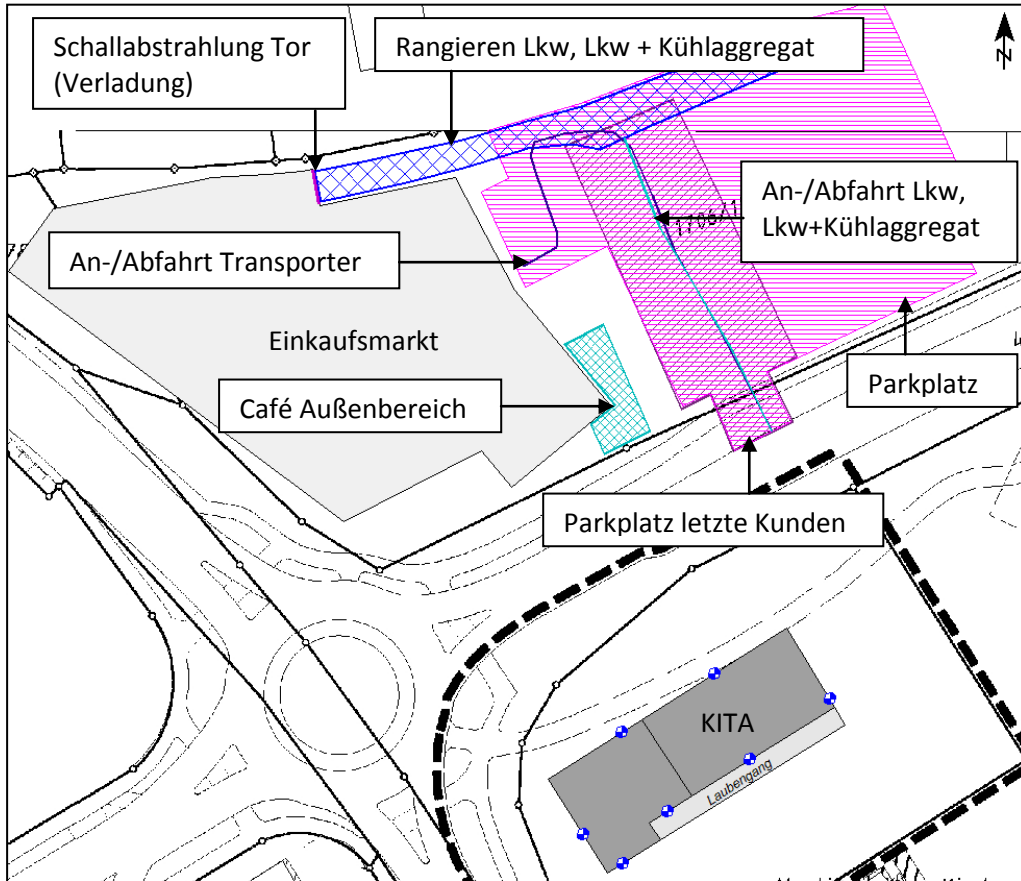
Lageplan geplanter Einkaufsmarkt¹
